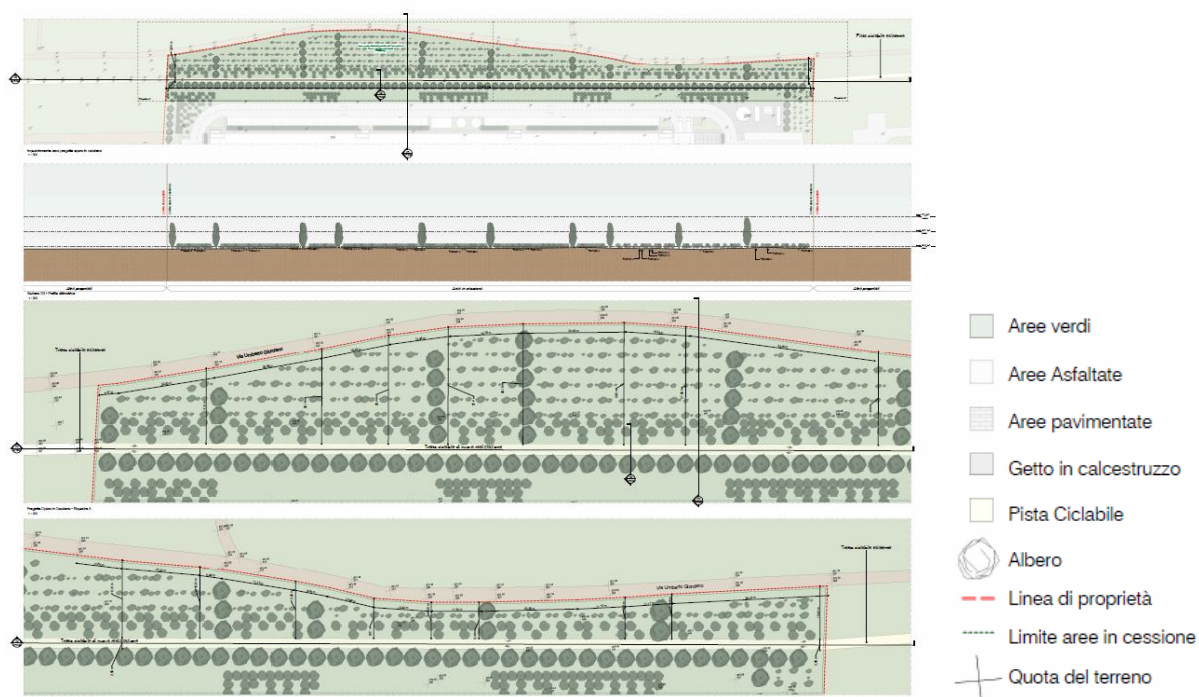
estratto tavola AC-0024 "Opere in Cessione - Pianta e sezioni"
